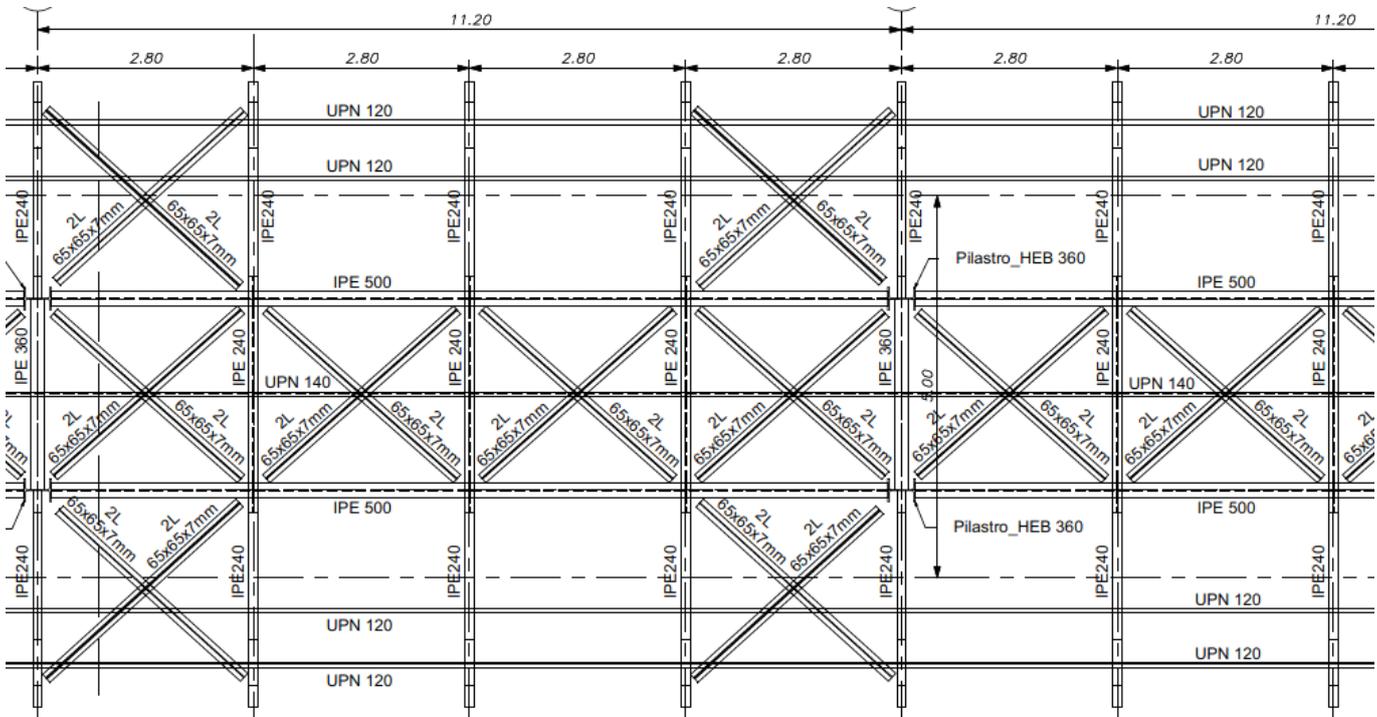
Strutture - Carpenteria metallica pensiline banchina
